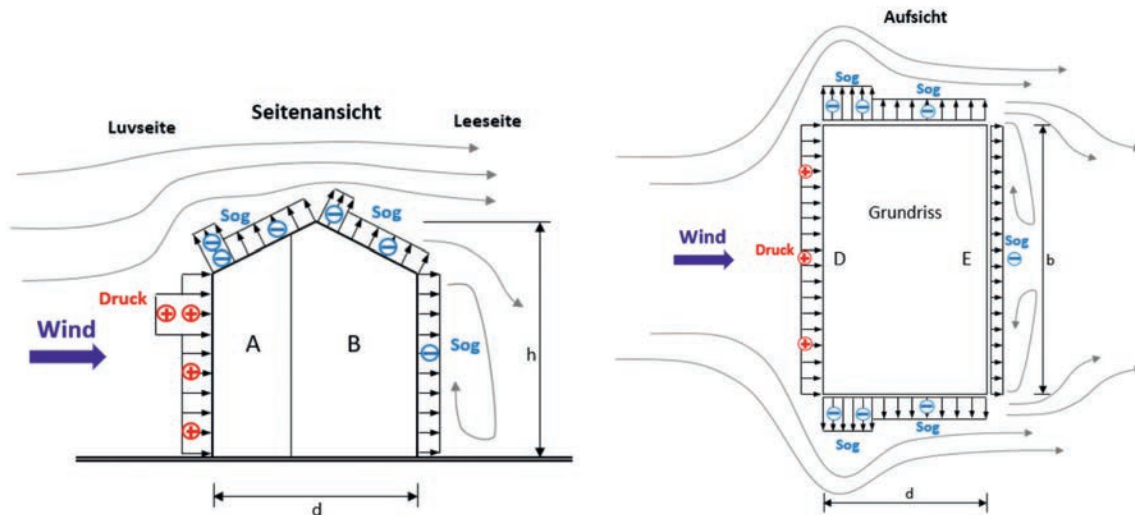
Vereinfachte Veranschaulichung der Umströmung eines freistehenden Gebäudes in der Seitenansicht (links) und im Grundriss (rechts) mit Druck- und Sogbereichen an den Dach- und Fassadenflächen
